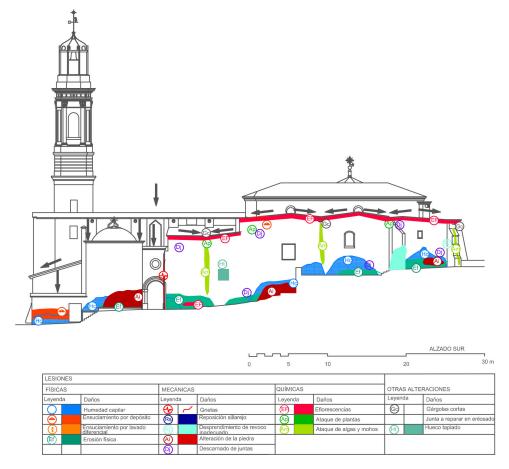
Plano de lesiones de la fachada sur y evolución constructiva de las cubiertas (Monjo et al: 2015).
